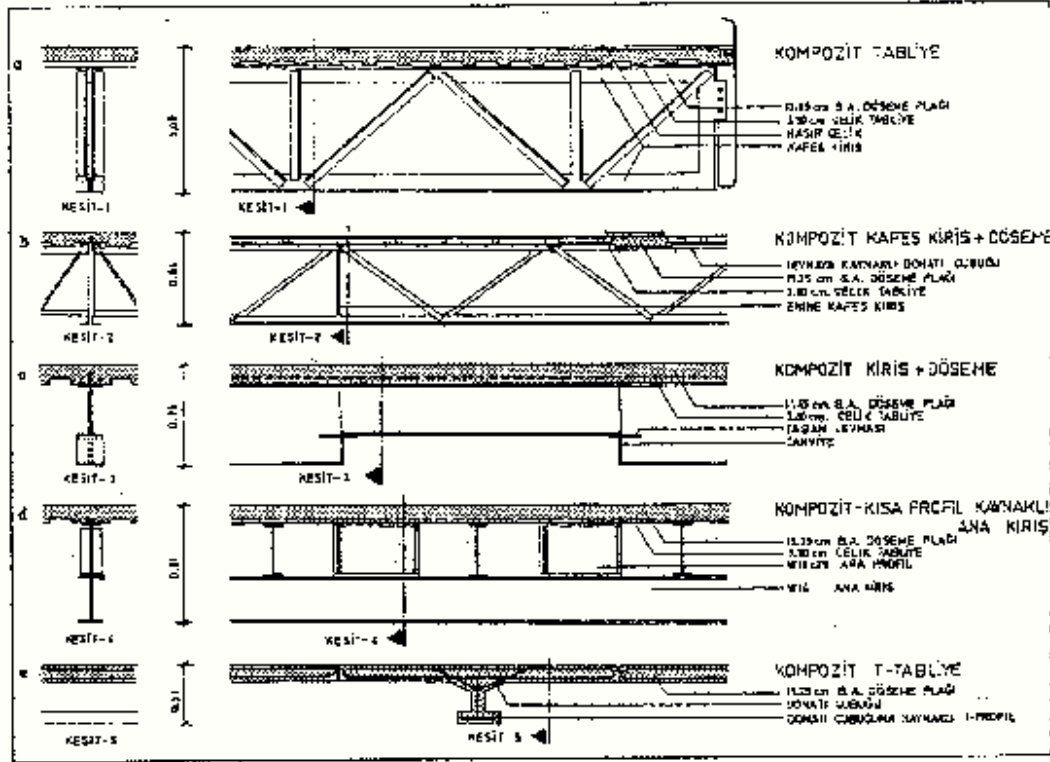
Prefabrike betonarme plak kompozit döşemeler.
